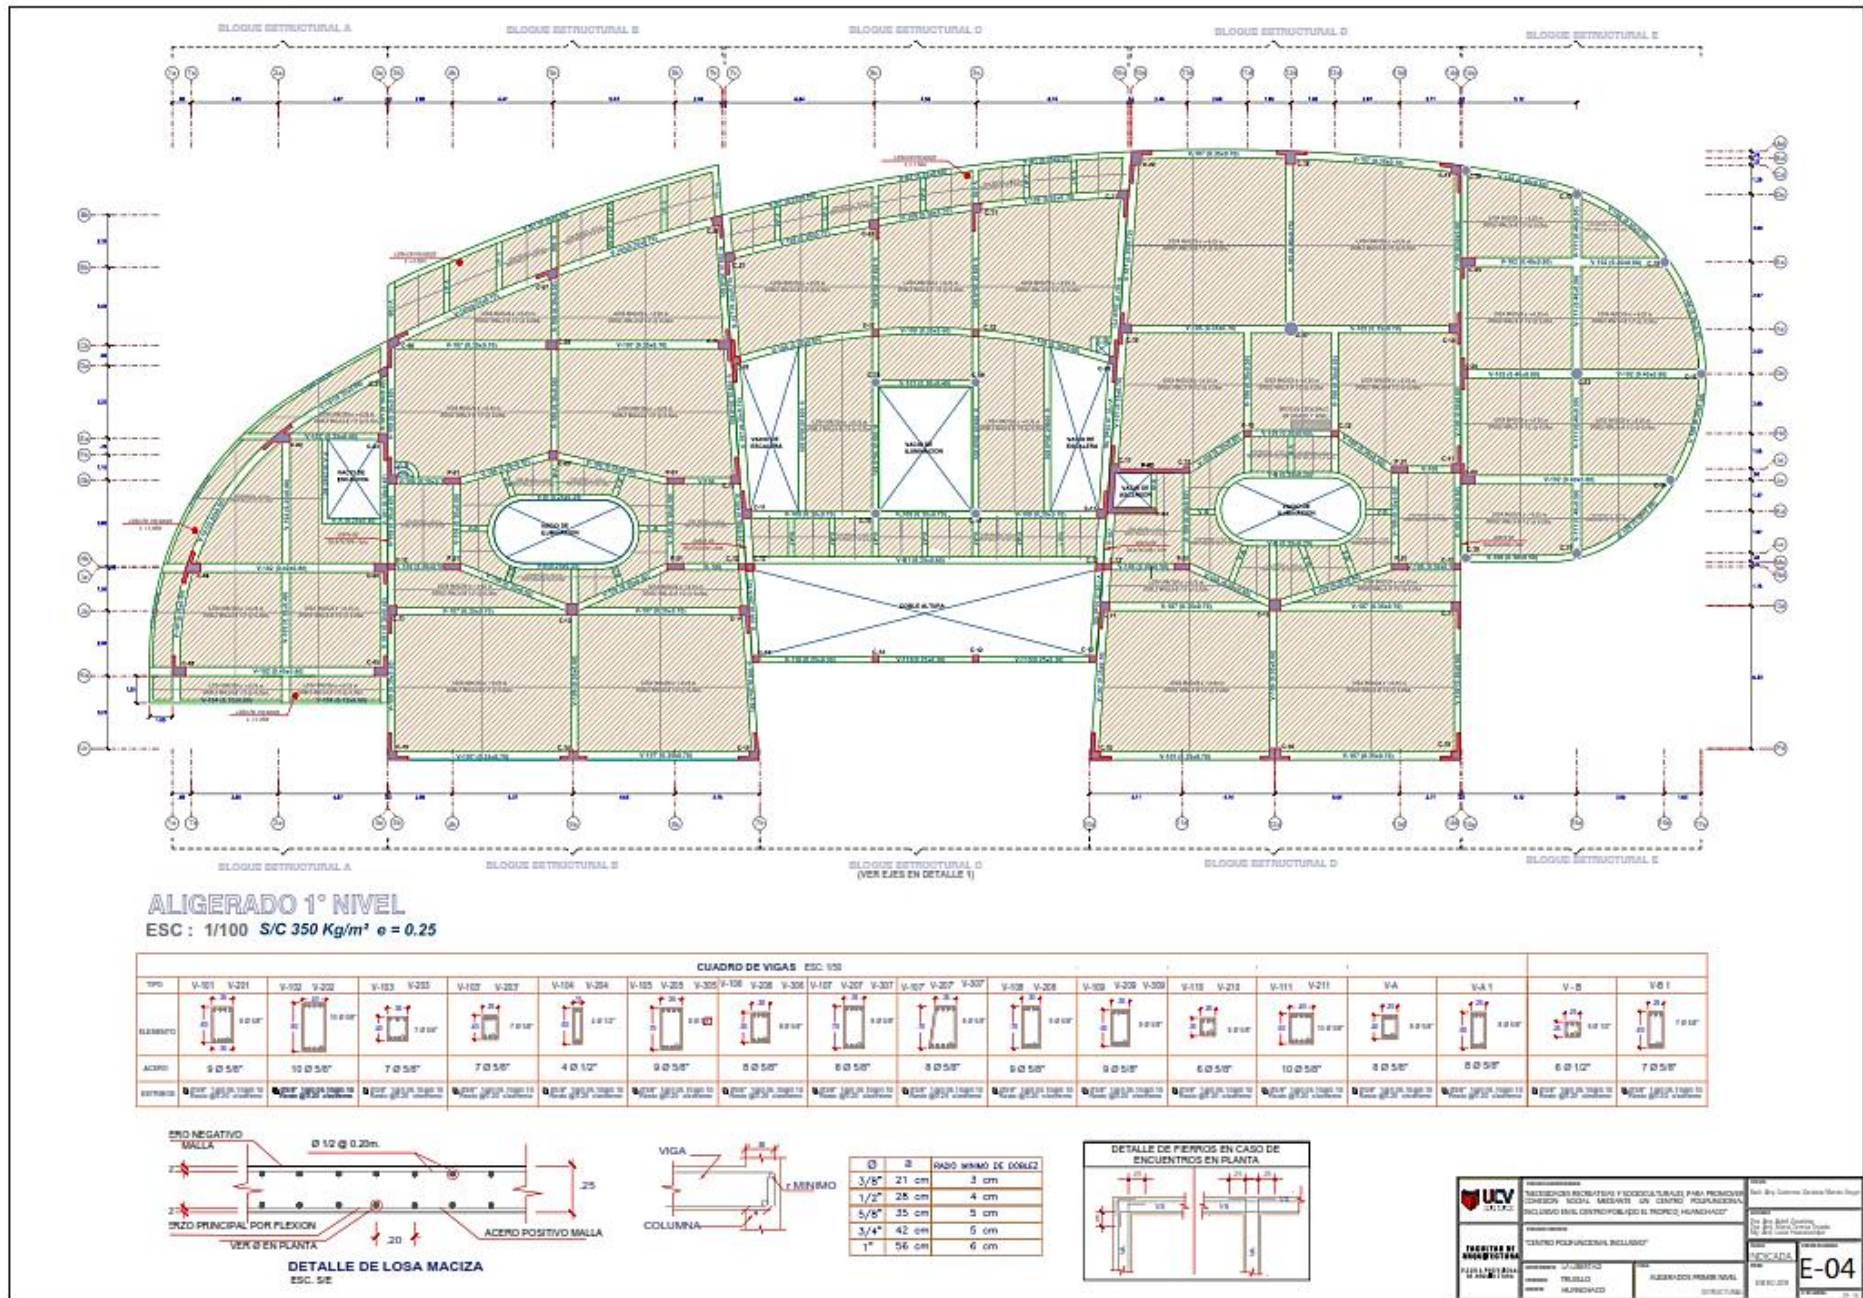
Plano Estructural. Aligerado del primer nivel: E-04. Fuente: Propia (2018)
